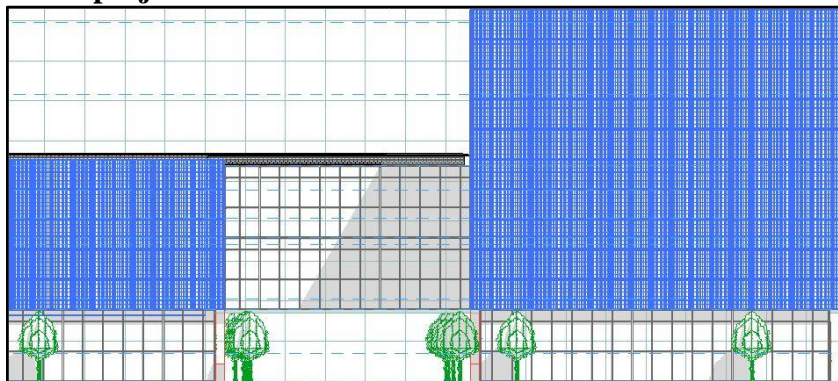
Mur solaires sur la façade sud du projet Source : (auteur)
